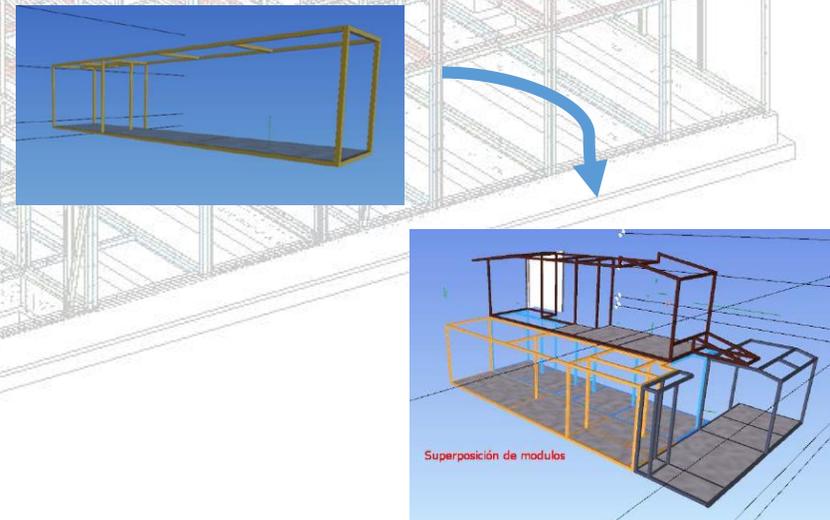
Módulos apilables en cualquier dirección y altura. Fuente Elaboración propia
